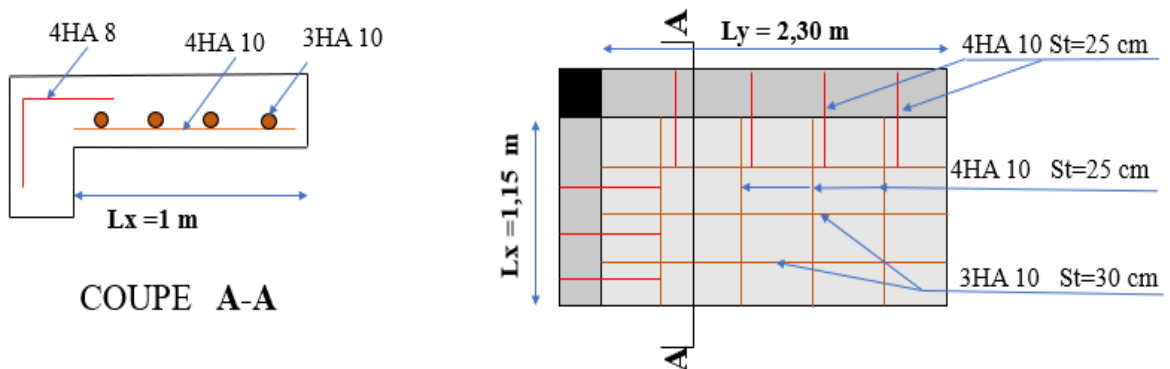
Schéma de ferrailage sur deux appuis (DP2).
